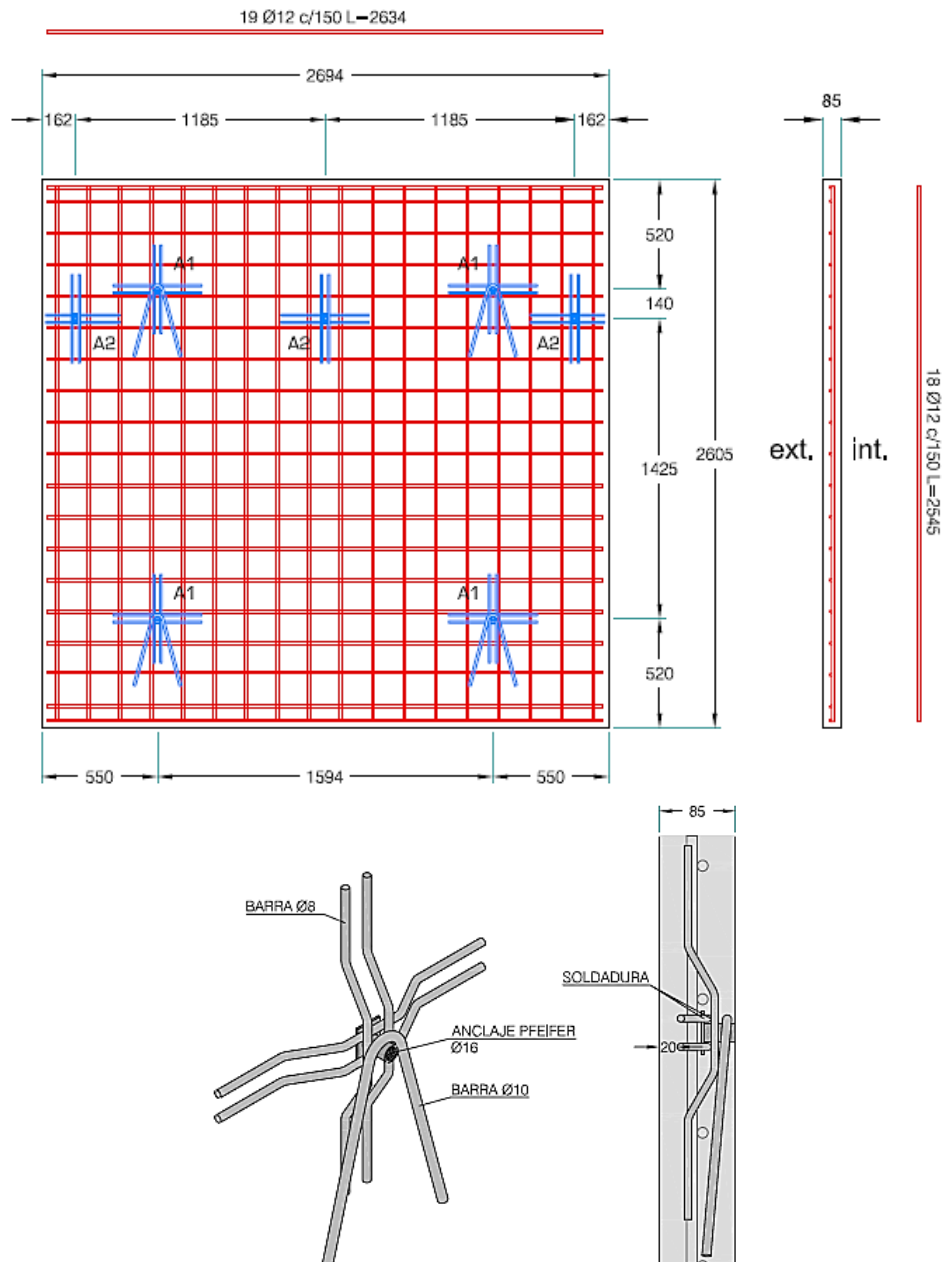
Detalles constructivos de la placa de hormigón armado y de los anclajes Pfeifer para su manipulación
